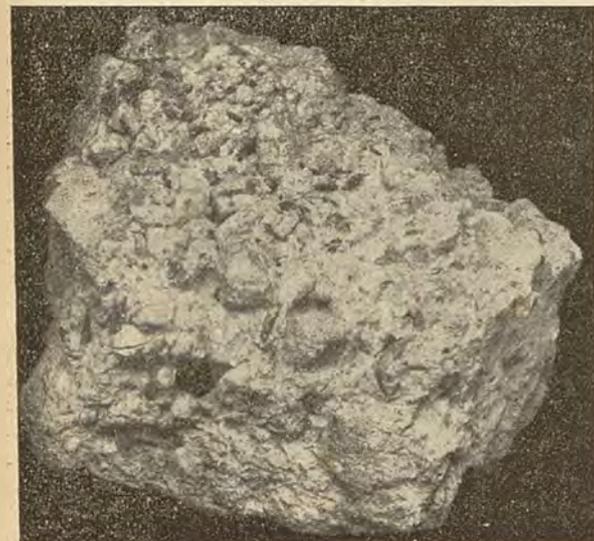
Aspetto cavernoso del calcestruzzo del ponte del Colombaro.
